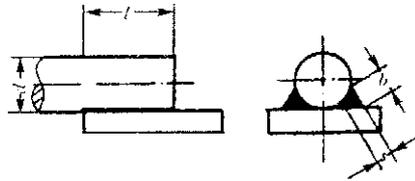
钢筋与钢板搭接焊接头
